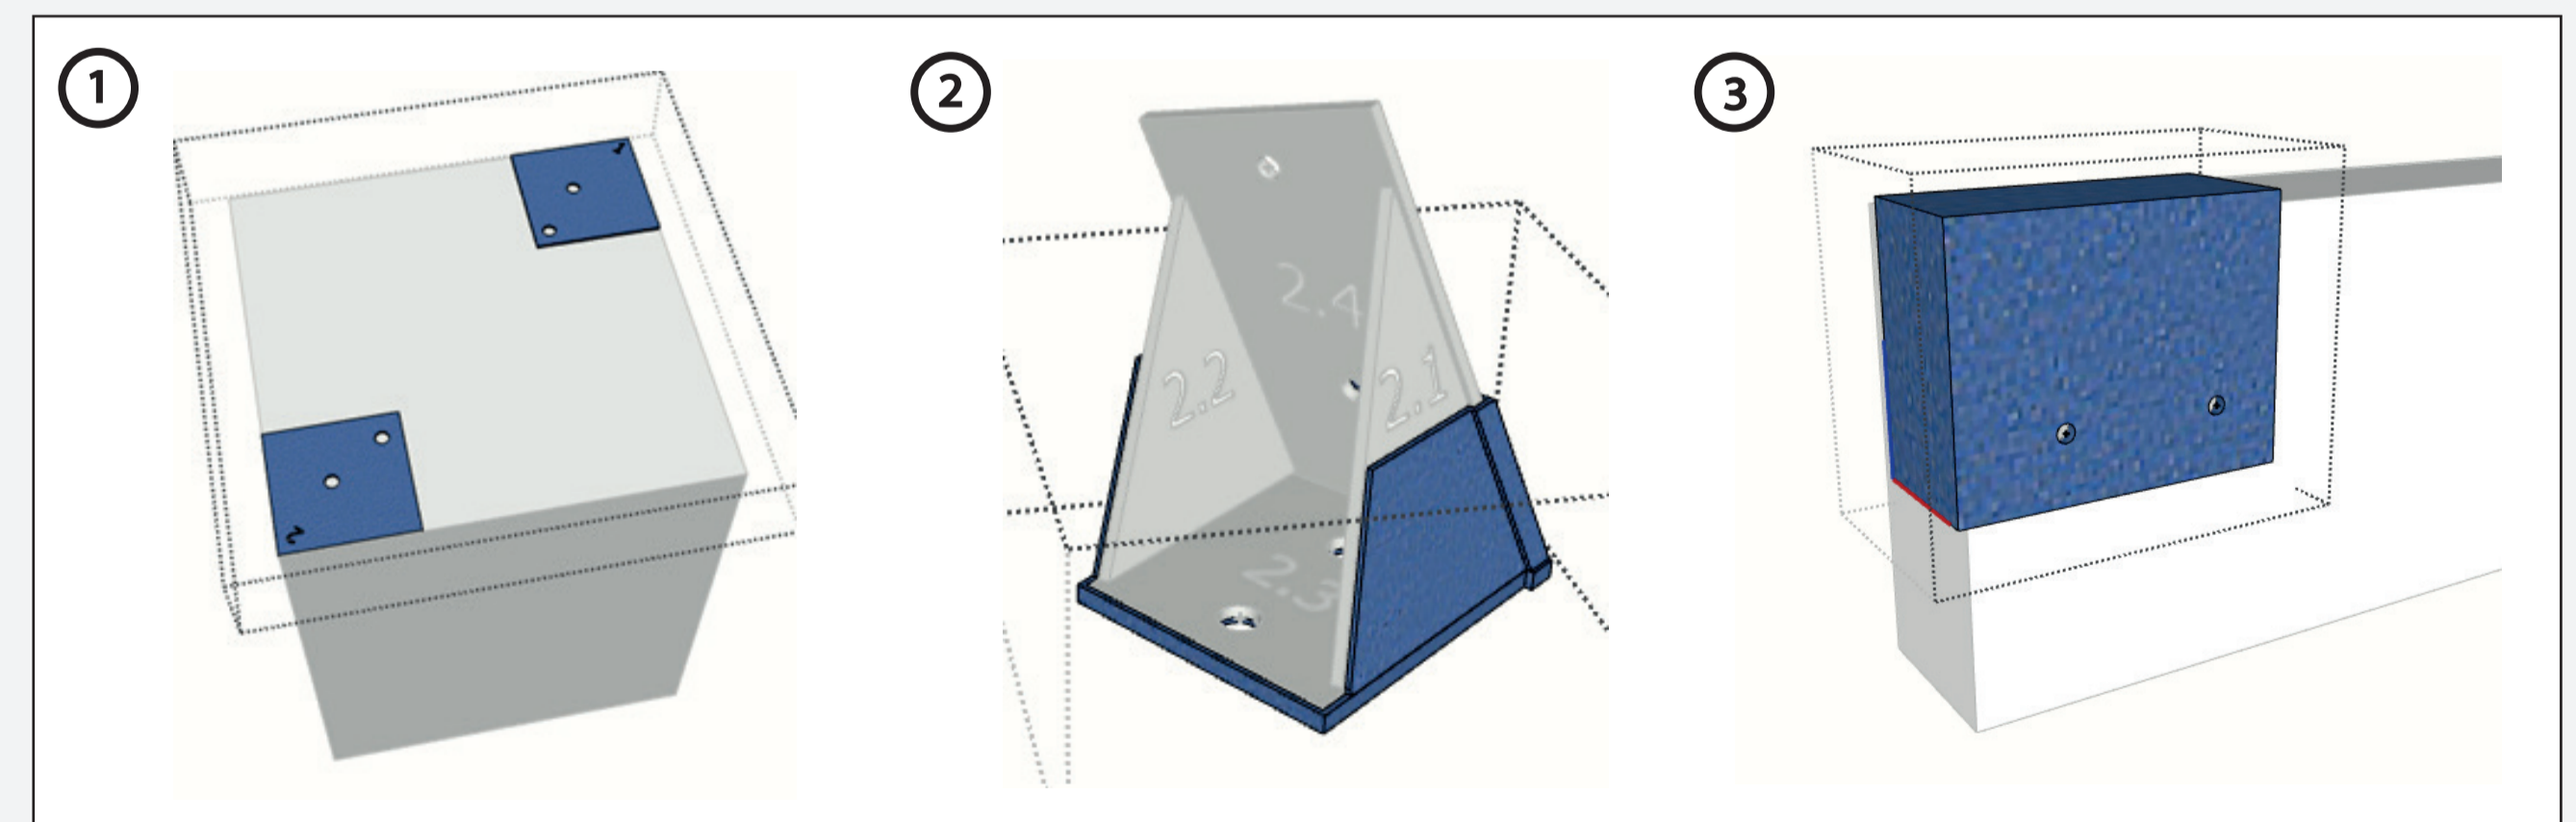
Diseños de plantillas imprimibles en 3D; (1) Plantilla para la ubicación de los pernos de anclaje en las bases de concreto; (2) Plantilla para la inclinación del soporte de acero en las bases de concreto; (3) Plantilla para la ubicación de las perforaciones de las vigas de madera.
